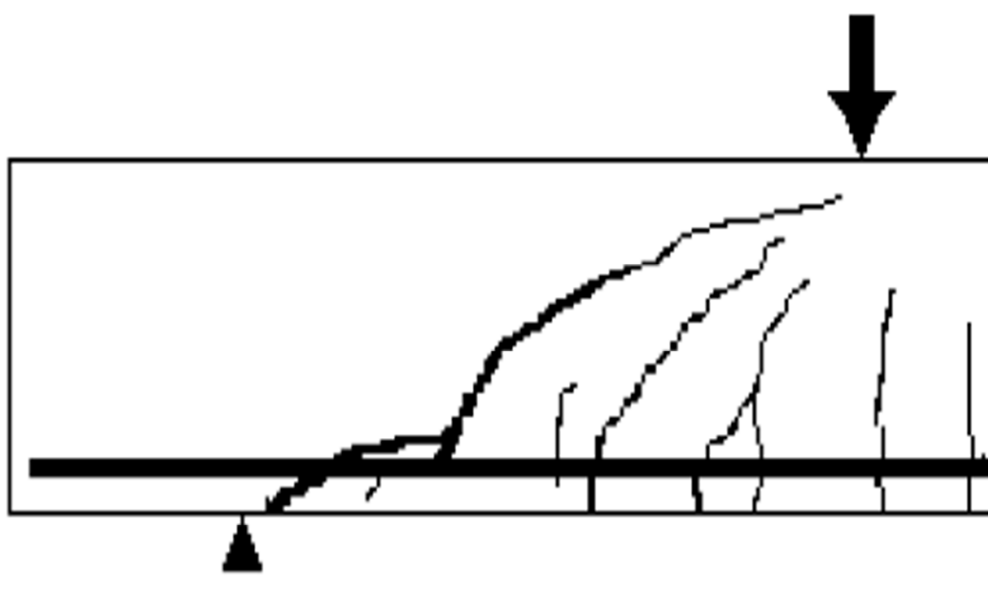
Padrão de fissuração observado no experimento.
